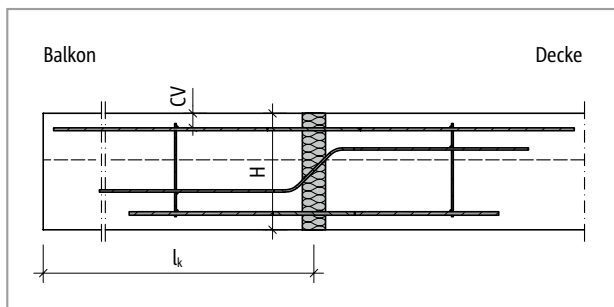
Schöck Isokorb® T Typ B: Statisches System
